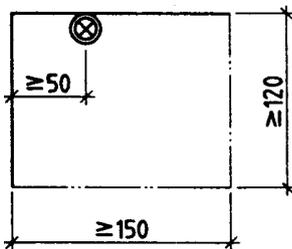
Bewegungsfläche neben Bedienungsvorrichtungen
